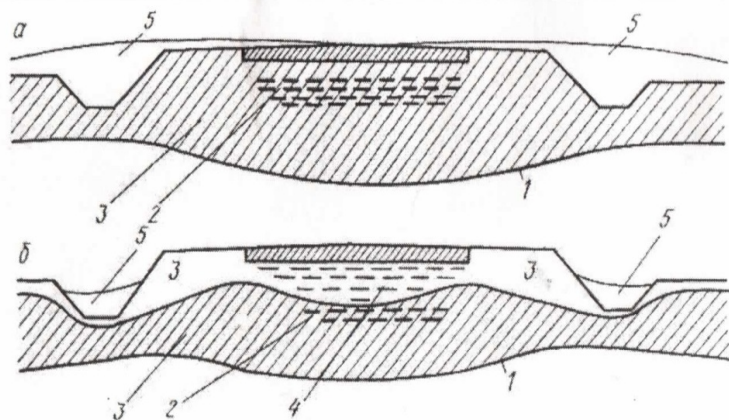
Образование донника: а – промерзание грунта под проезжей частью;б – оттаивание грунта весной: 1– граница промерзания; 2– ледяные линзы; 3– мерзлый грунт; 4– оттаявший сильно переувлажненный грунт; 5– снег.
